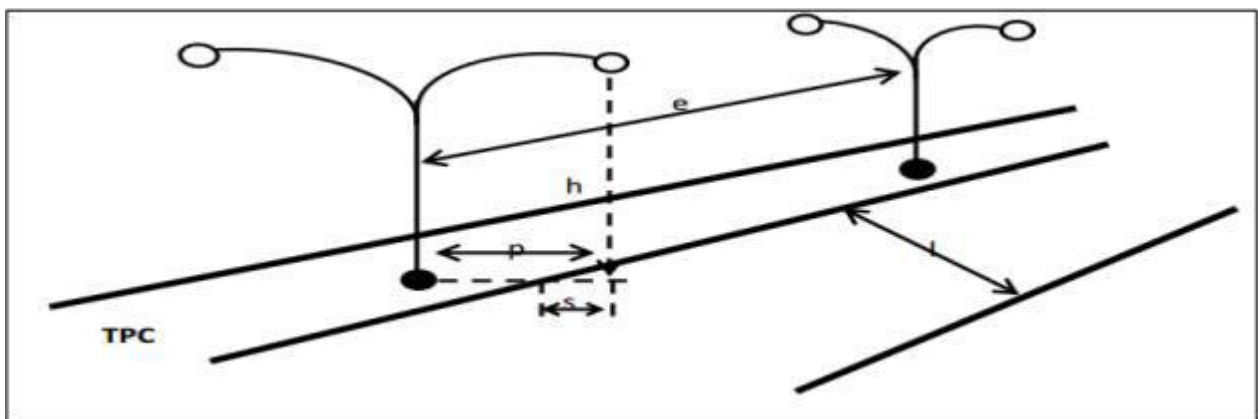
Les paramètres de l'implantation des luminaires.
